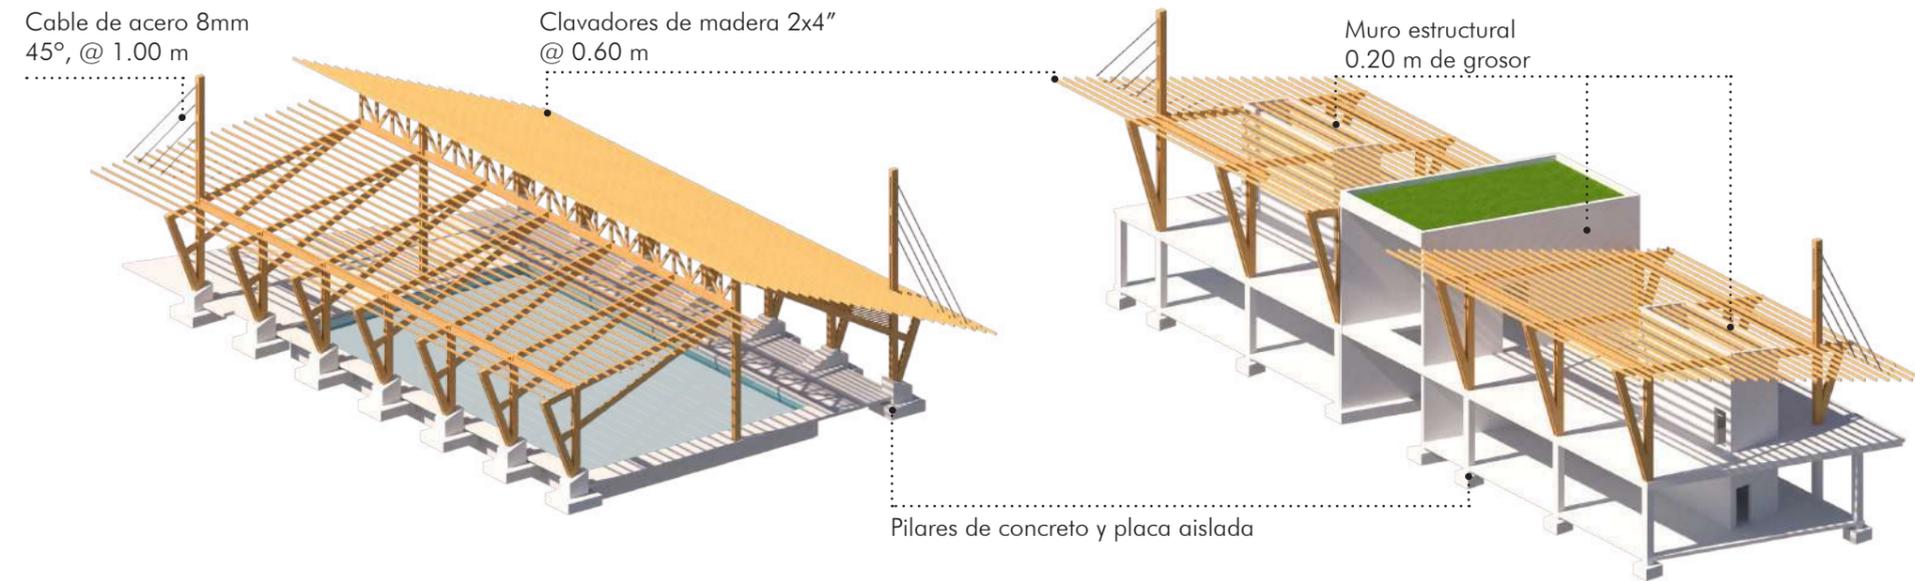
Elementos estructurales en el edificio deportivo. Elaboración propia.
